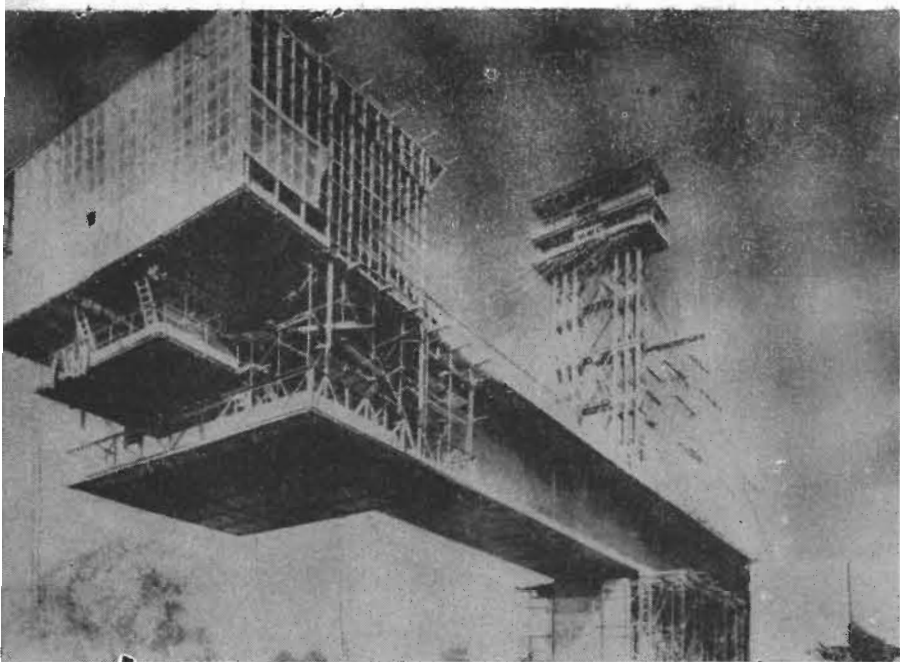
Cimbra en voladizo y pilón durante la construcción de la sección II del puente Bendorf.
